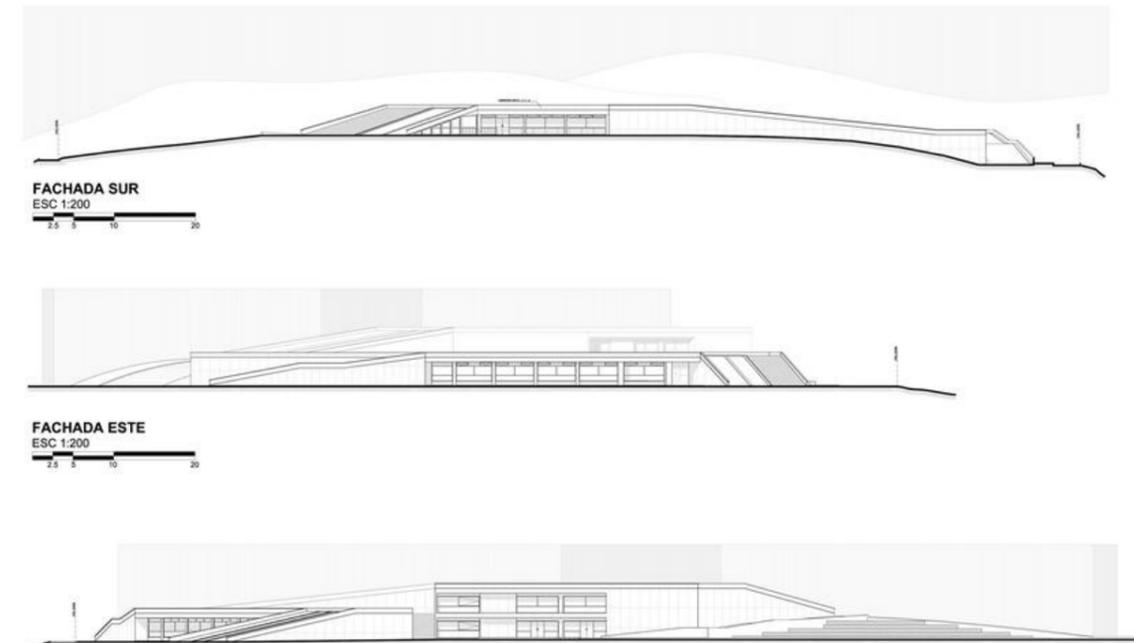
Planos arquitectónicos, fachadas del Centro Comunitario Quitumbe.
